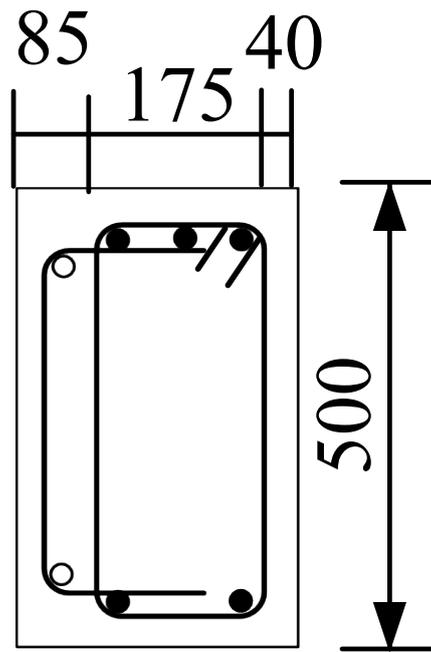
RH/SU 梁試體斷面圖(輔助筋 D13)(單位：mm)
